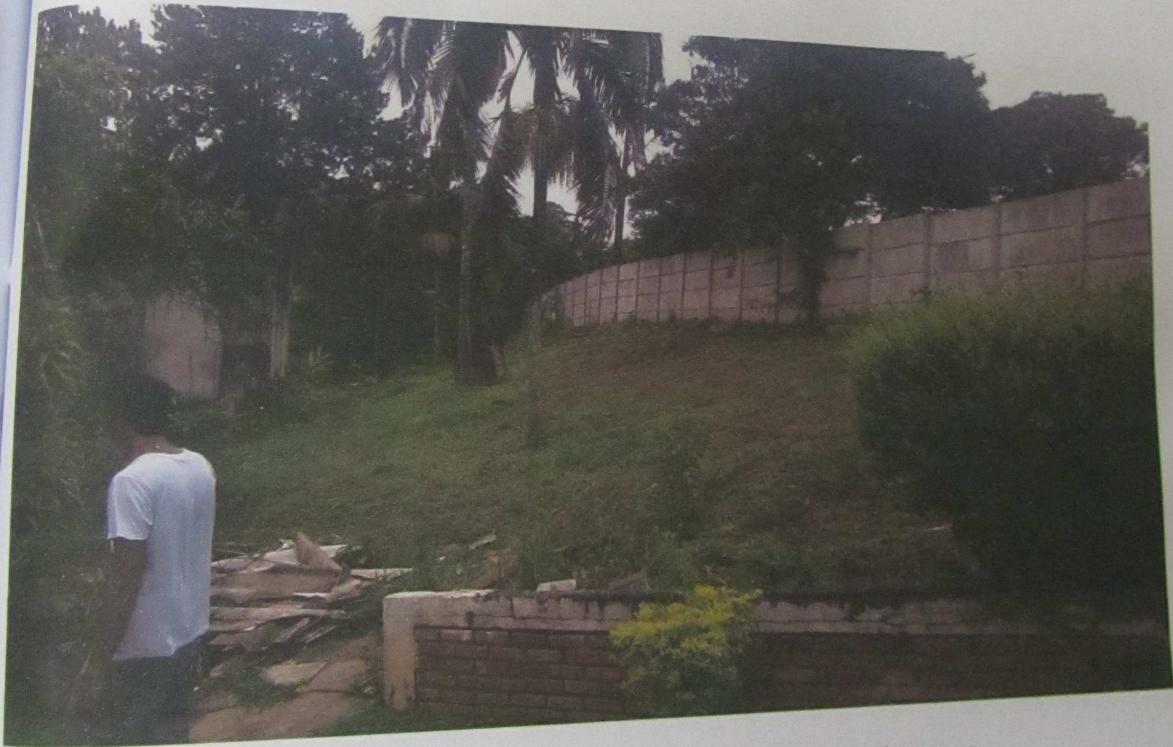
Vista do muro divisório para a rua, a partir do terreno
